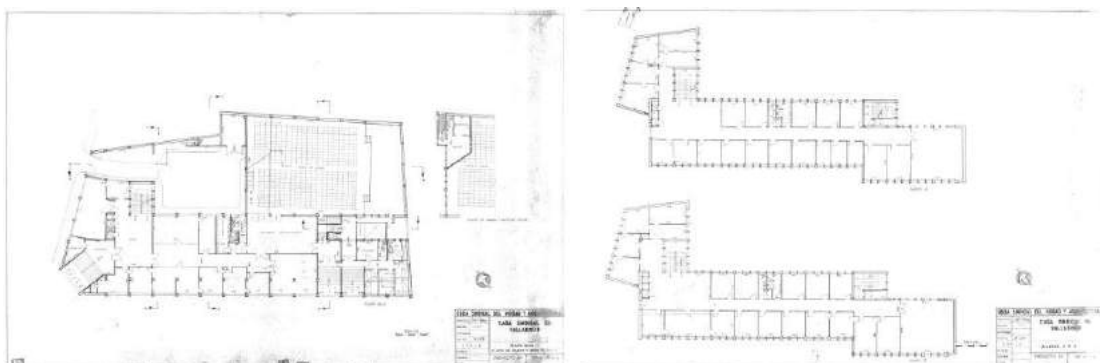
Planta baja y plantas 2 y 3. Fechado 31-1-1959. (Foto: Archivo del Arquitecto.)
